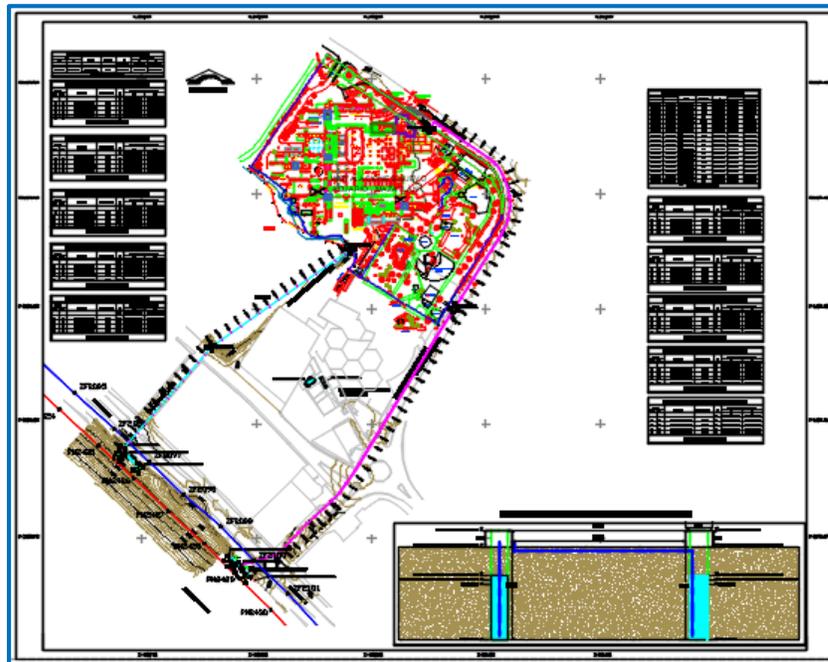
AC\_PLANO 1.1.dwg o AC\_PLANO 1.1.pdf.
